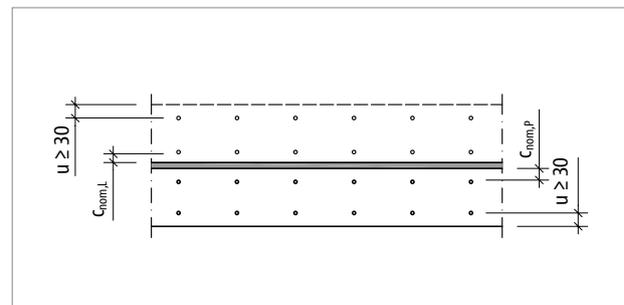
Schöck Tronsole® Typ F: Vertikalschnitt quer zur Treppe im Bereich des Konsolauflagers; Darstellung der Betondeckung $c_{nom,L}$, $c_{nom,P}$ und des Mindestachsabstandes u der Bewehrung
